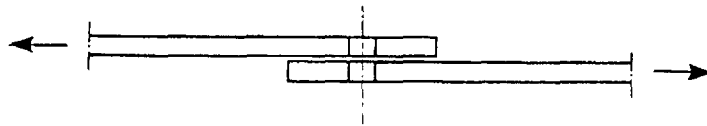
Einschnittige Verbindung mit einer Schraubenreihe
